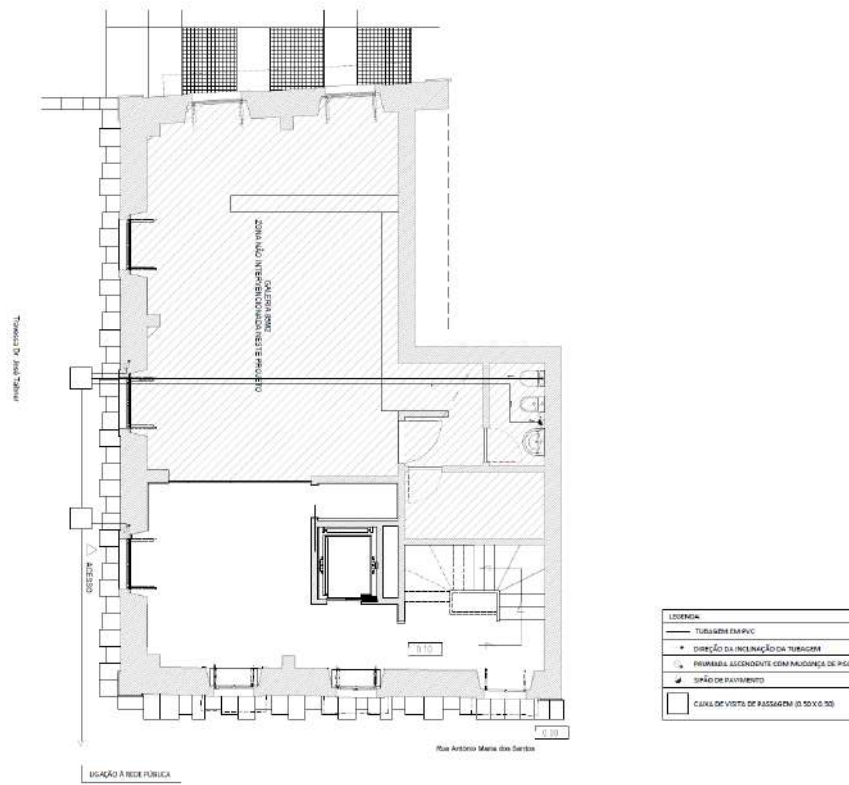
Planta de Sistema de Drenagem Predial de Águas Residuais - Piso 0
